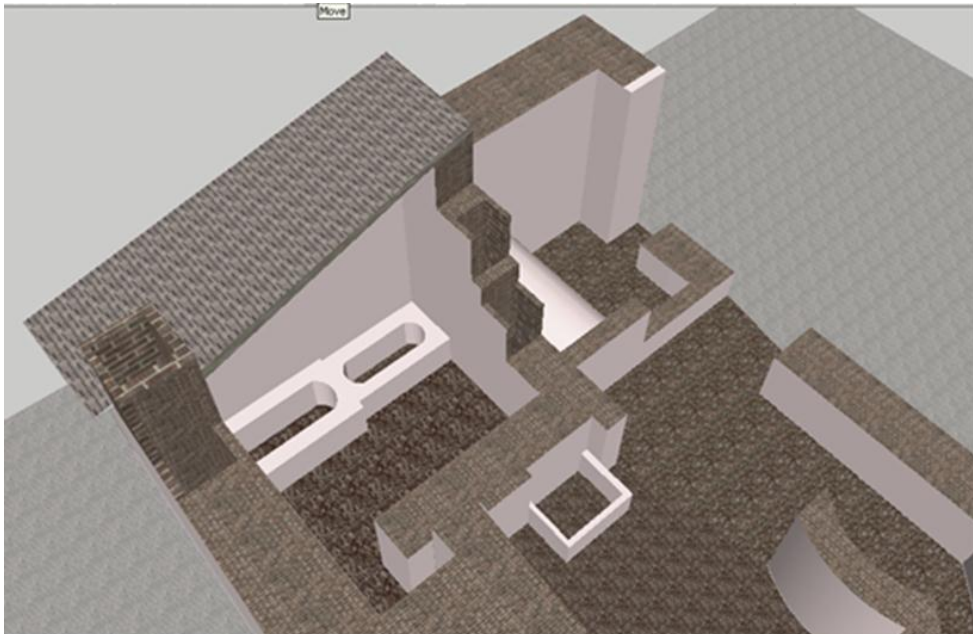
مسقط أفقي تقريبي مستكمل يظهر الشكل الكامل المتوقع لحمام كوم الجيزة اليوناني.
